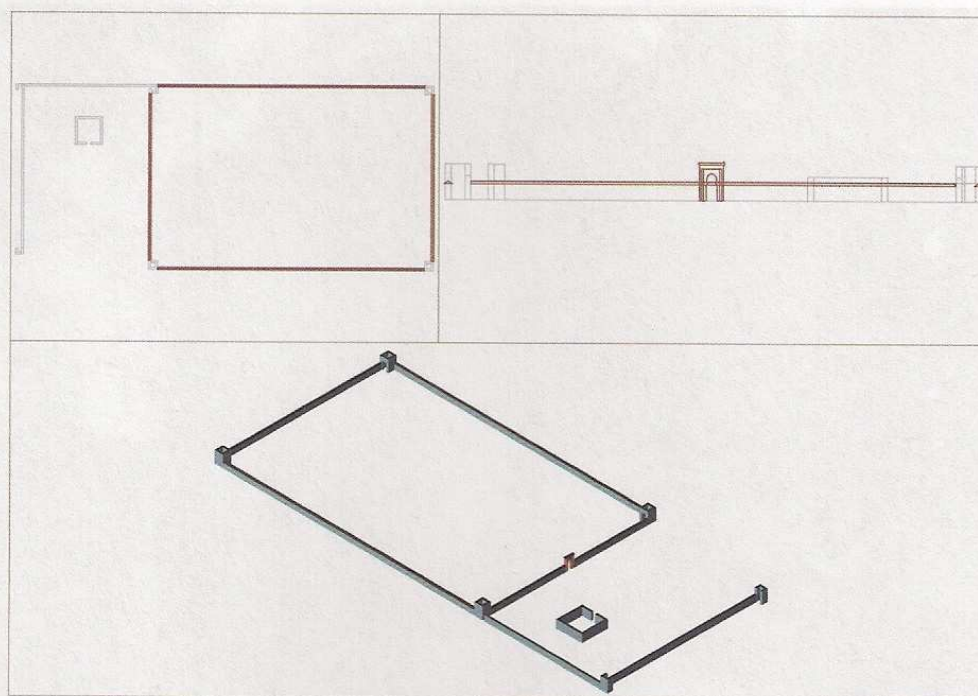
Planta, alzado y visión tridimensional del cementerio de Barcia (diseño de Jesús Ignacio Jiménez Chaparro).
